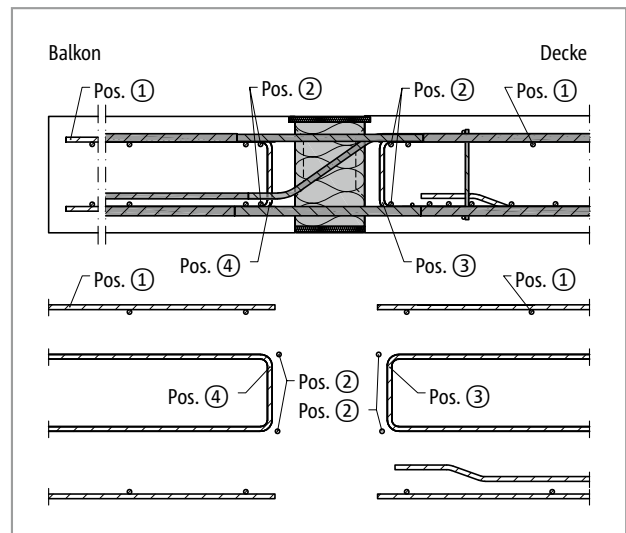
Schöck Isokorb® XT Typ K-M12 bis M13: Bauseitige Bewehrung bei indirekter Lagerung
